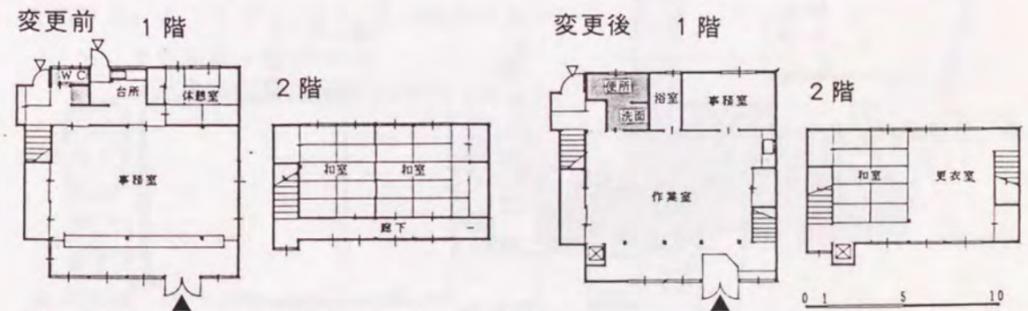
<20>北区社会福祉会館(旧出張所)平面図
